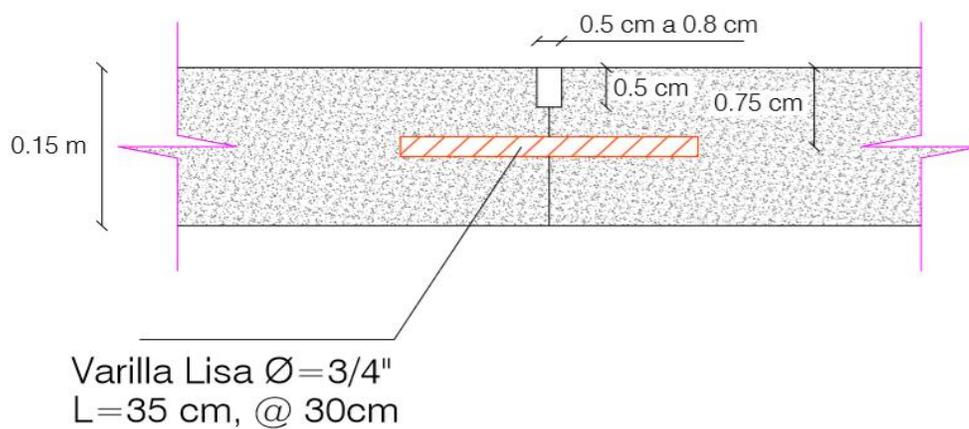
Detalle de junta de transversal en pavimento rígido. Fuente: AMO, 2019.
